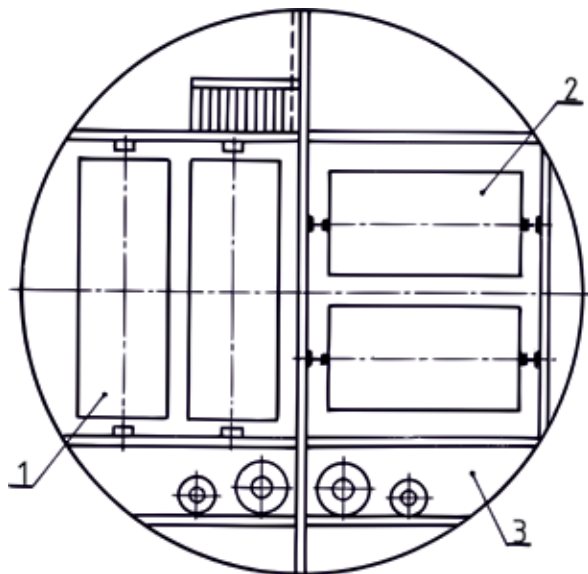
Przykłady przepływu powietrza w jednym szymbie w dwóch kierunkach:
